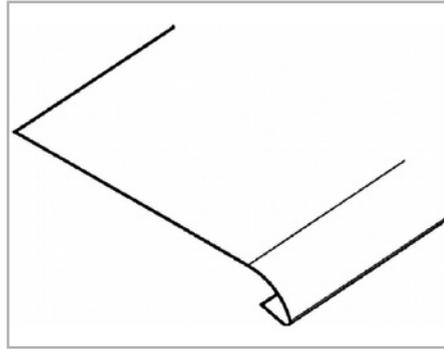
Metallblechan-schlüsse müssen beweglich eingebaut und mit Dehnungsausgleichern ausgerüstet sein.
